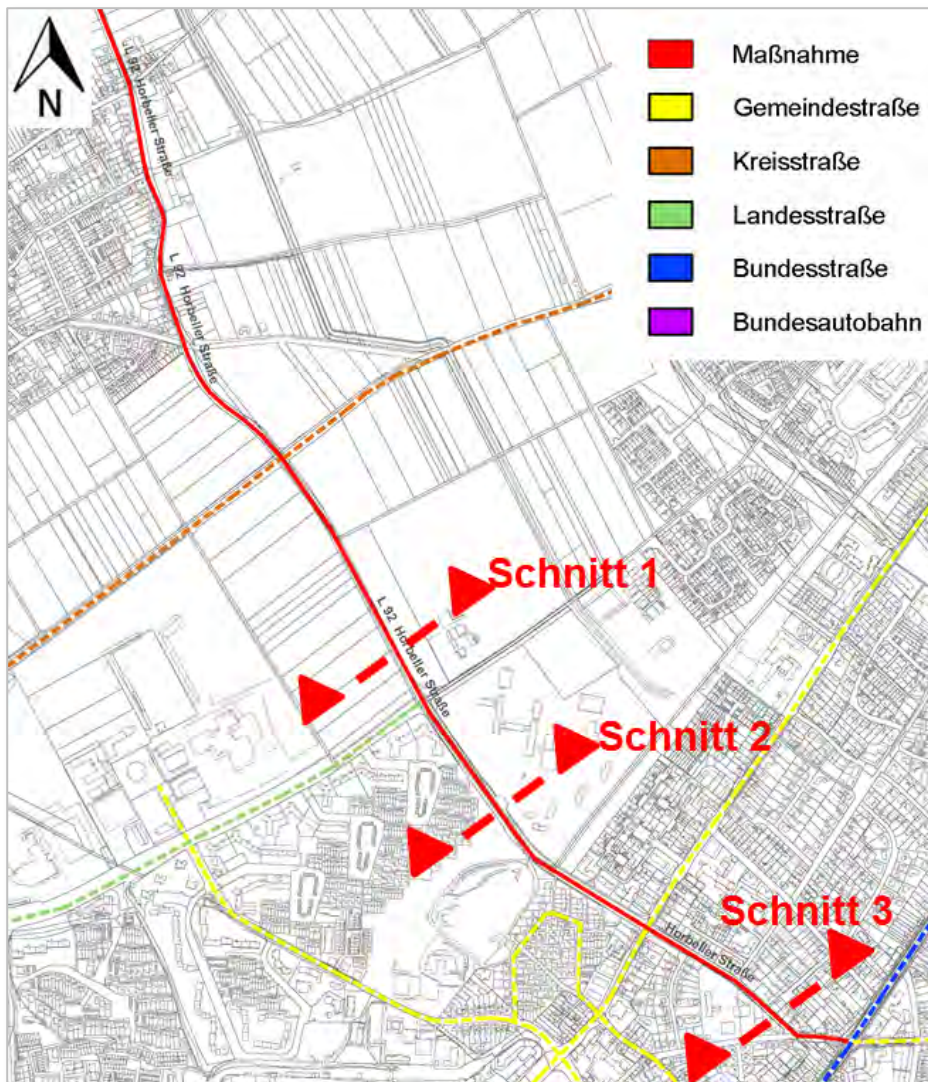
Lageplan „o1“-Maßnahme L 92 Horbeller Straße
